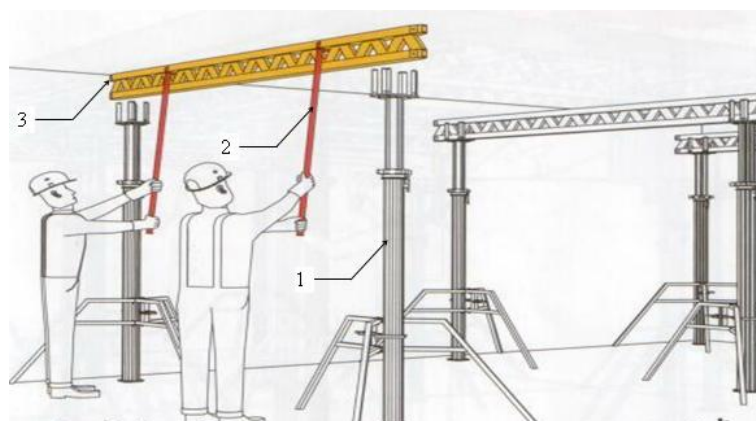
Монтаж продольных балок: 1 — основная стойка с треногой и унивилкой; 2 — монтажная штанга; 3 — монтируемая продольная балка
